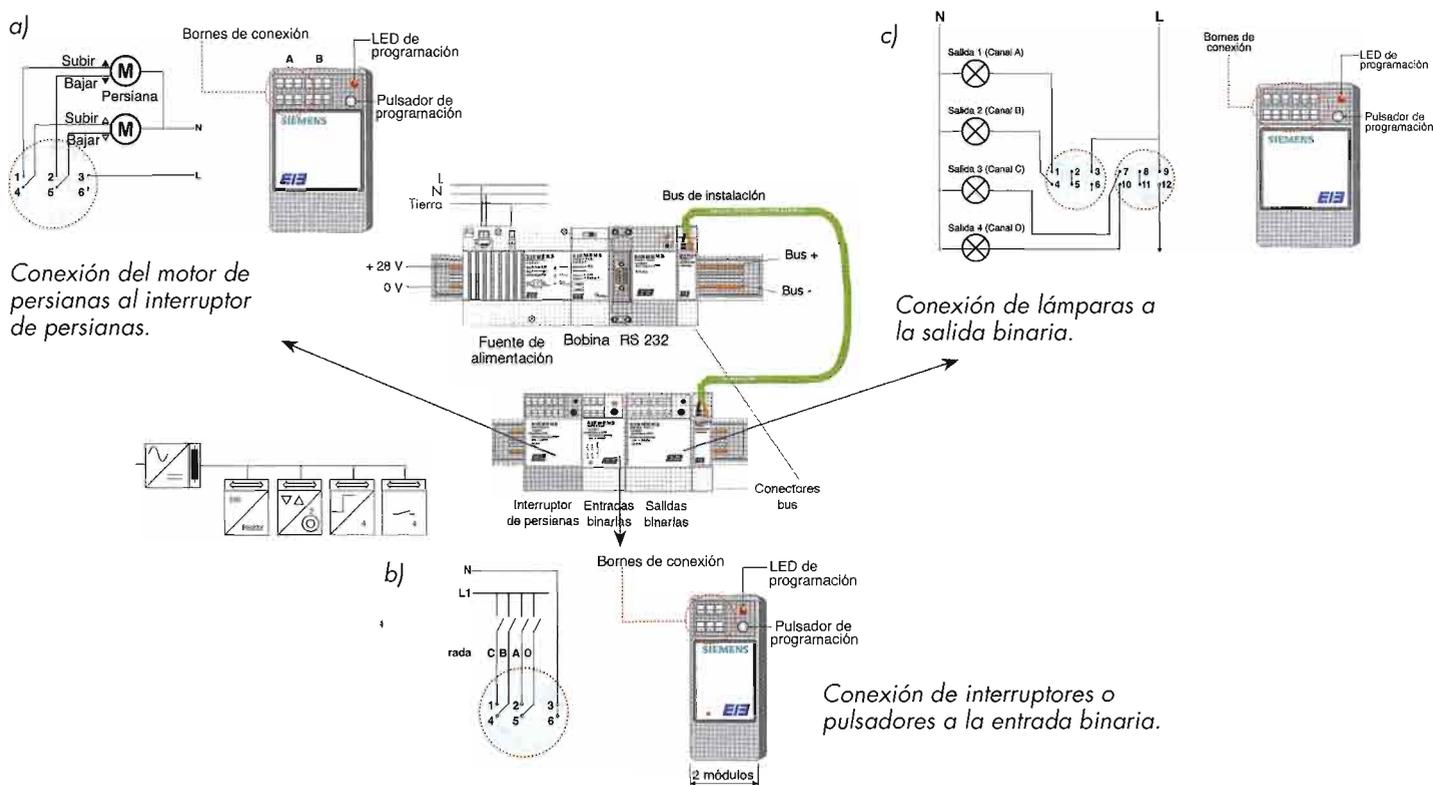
Instalación de componentes KNX sobre carril DIN. (Fuente: Siemens.)
